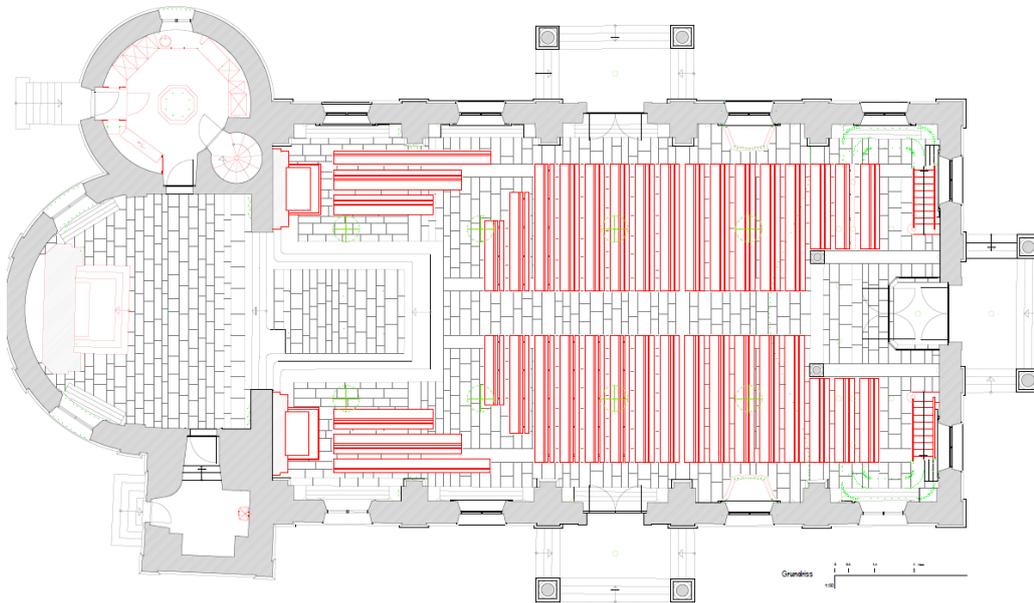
Kirche St. Urs und Viktor Kestenholz / Grundriss
